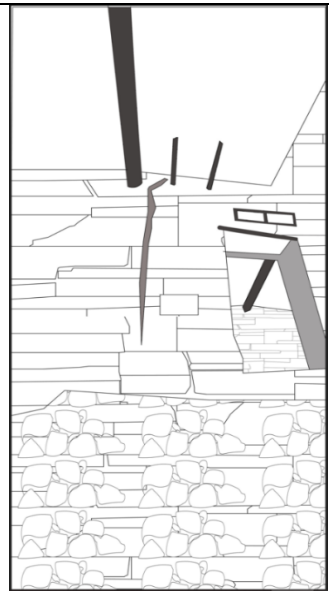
قرية الكلادا: بيت رقم (٥٩)، مدخل الطابق الأول (عمل الباحث).
